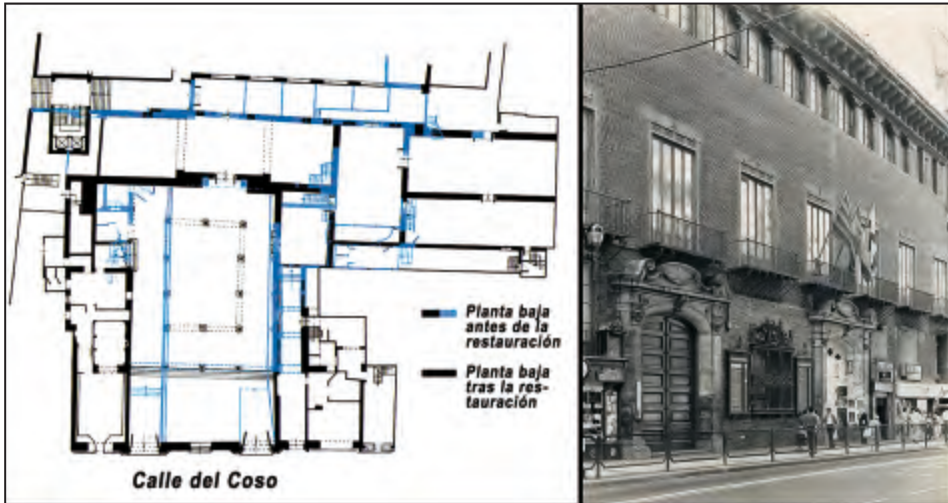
Superposición de plantas de la planta baja del Palacio de Sástago. Fachada al Coso antes de su restauración (Fotografía procedente de los fondos de la DPZ).
